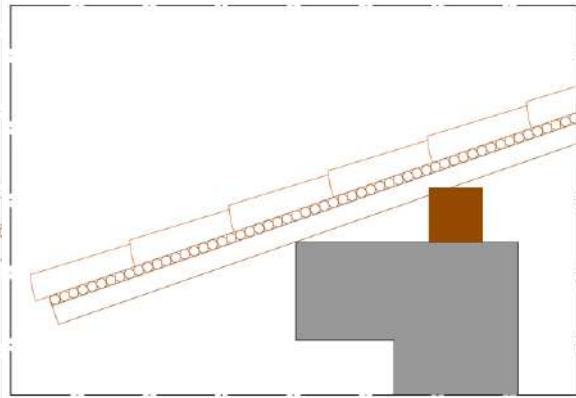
Detalle de alero, apoyo en muro perimetral.
